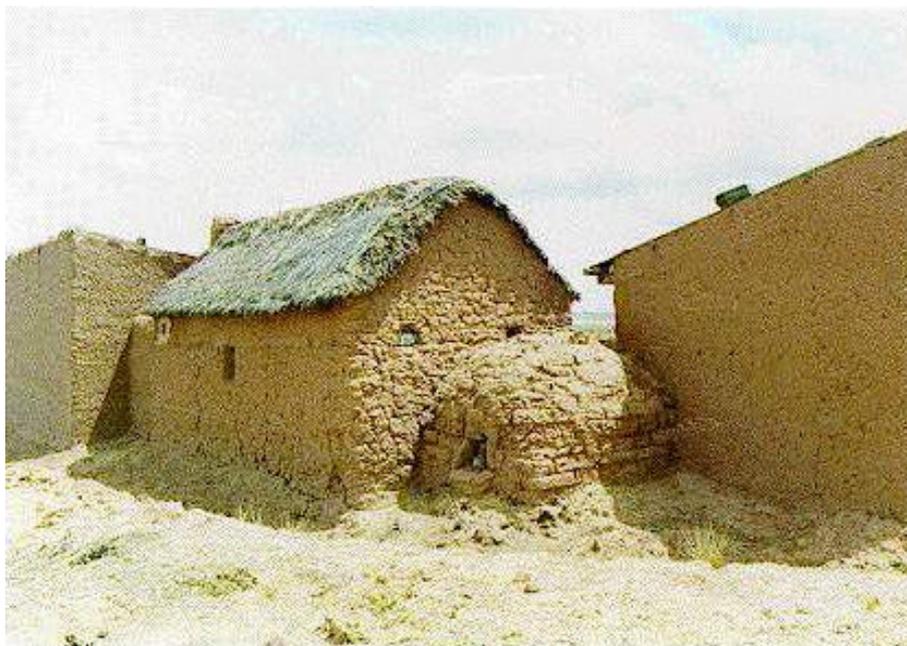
Precariedad constructiva en una vivienda rural en el Altiplano de Bolivia (Foto: A. Calla)
